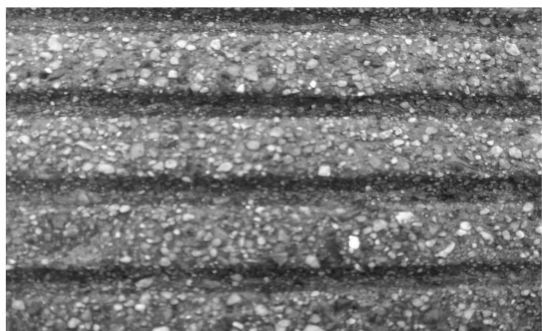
14.5 m 线上 620 m 处的道面表层构造外观特征
